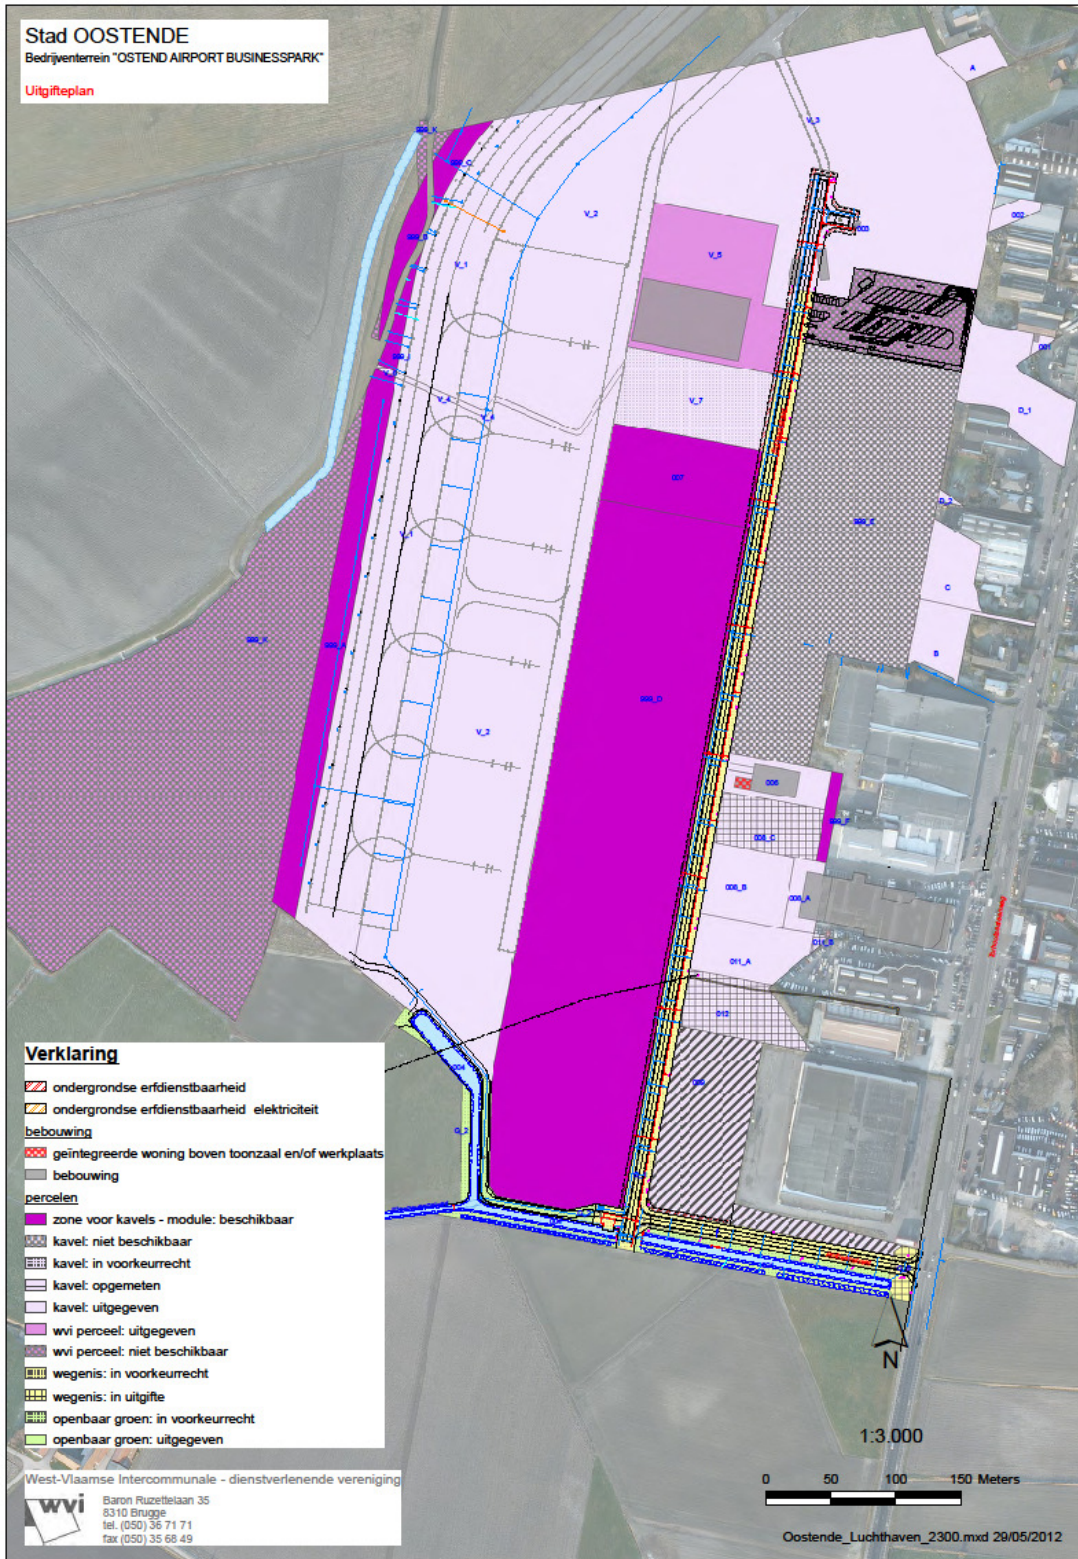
overzicht van de stedenbouwkundige vergunning, noordelijk deel 1
